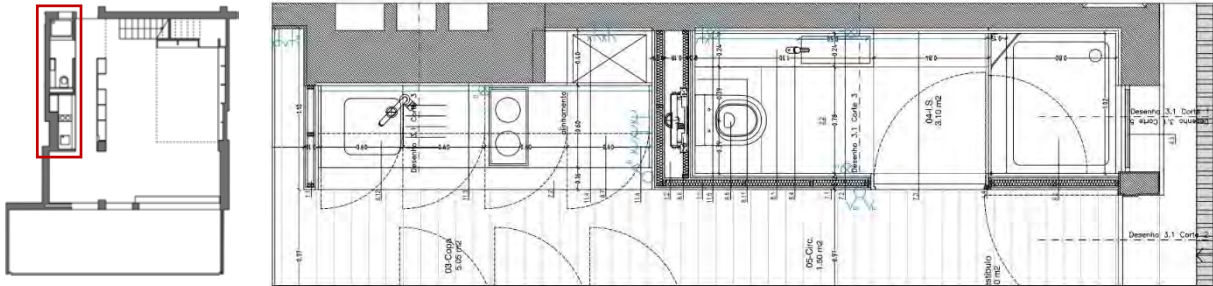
Planta Pormenor do volume da instalação sanitária e kitchenette
